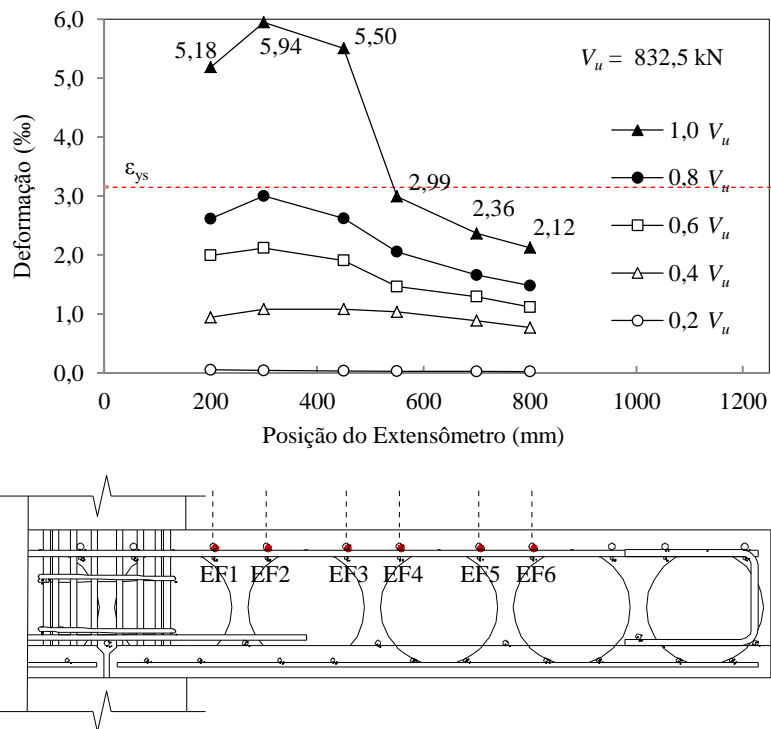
Deformações nas armaduras de flexão da laje BD2
